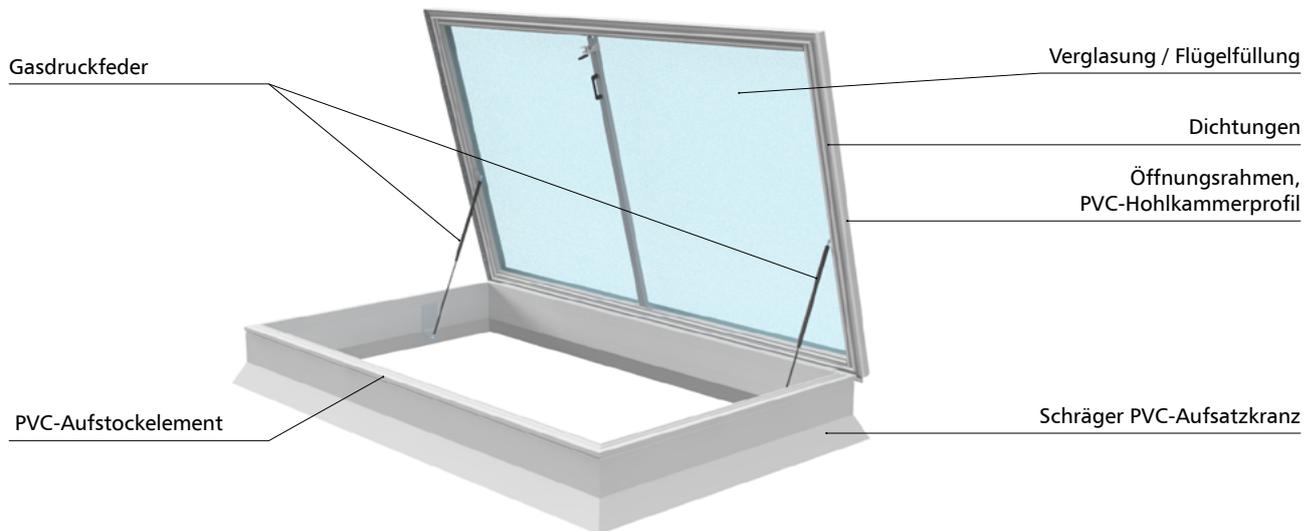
Aufbau eines Dachausstiegs mcr ULTRA THERM Typ NG-A
